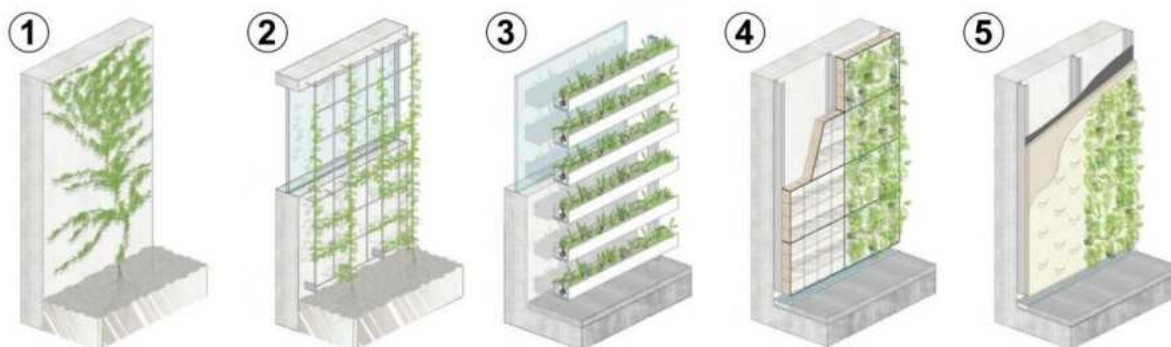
Ausbildungsförmungen von Fassadenbegrünungen. 1) Direktbewuchs mit Selbstklimmern, bodengebunden, 2) leitbarer Bewuchs an Kletterhilfen, bodengebunden, 3) Pflanzgefäße, horizontale Vegetationsflächen, wandgebunden, 4) modulares System (Living Wall), vertikale Vegetationsflächen, wandgebunden, 5) flächiges System (Living Wall), vertikale Vegetationsflächen, wandgebunden; basierend auf Bildquelle [5]
